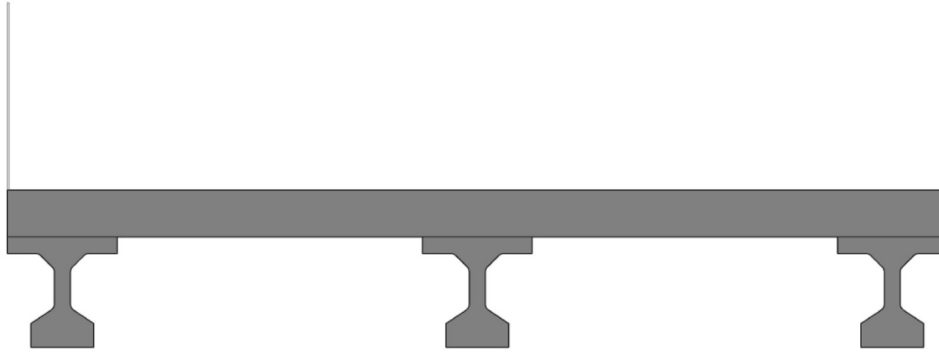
Sección perpendicular vano simple de hormigón pretensado
